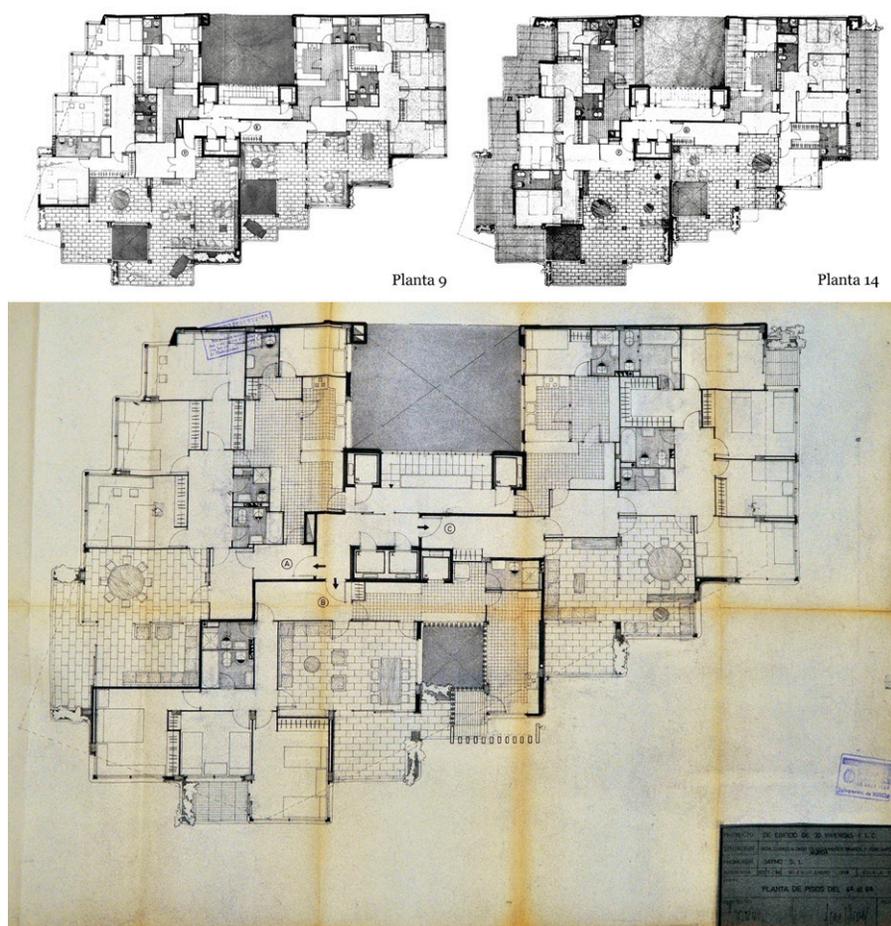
/ Escario-Vidal-Vives (Evv): Edificio 'Vitalicio', planos de plantas 9ª y 14ª, 1968 (arriba). Plano de planta tipo 4ª a 8ª (abajo)
